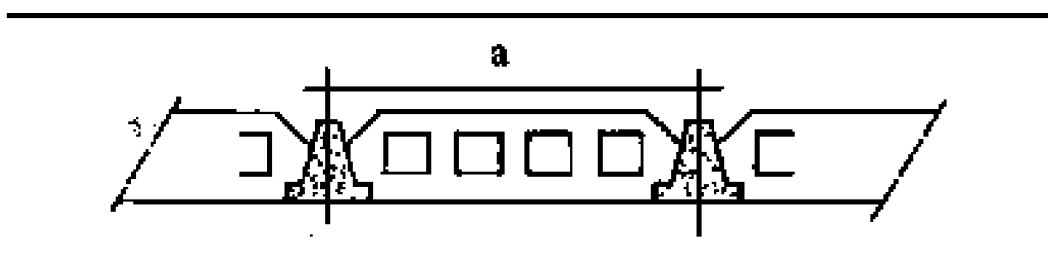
Disposição dos elementos de uma laje pré-fabricada [2].
